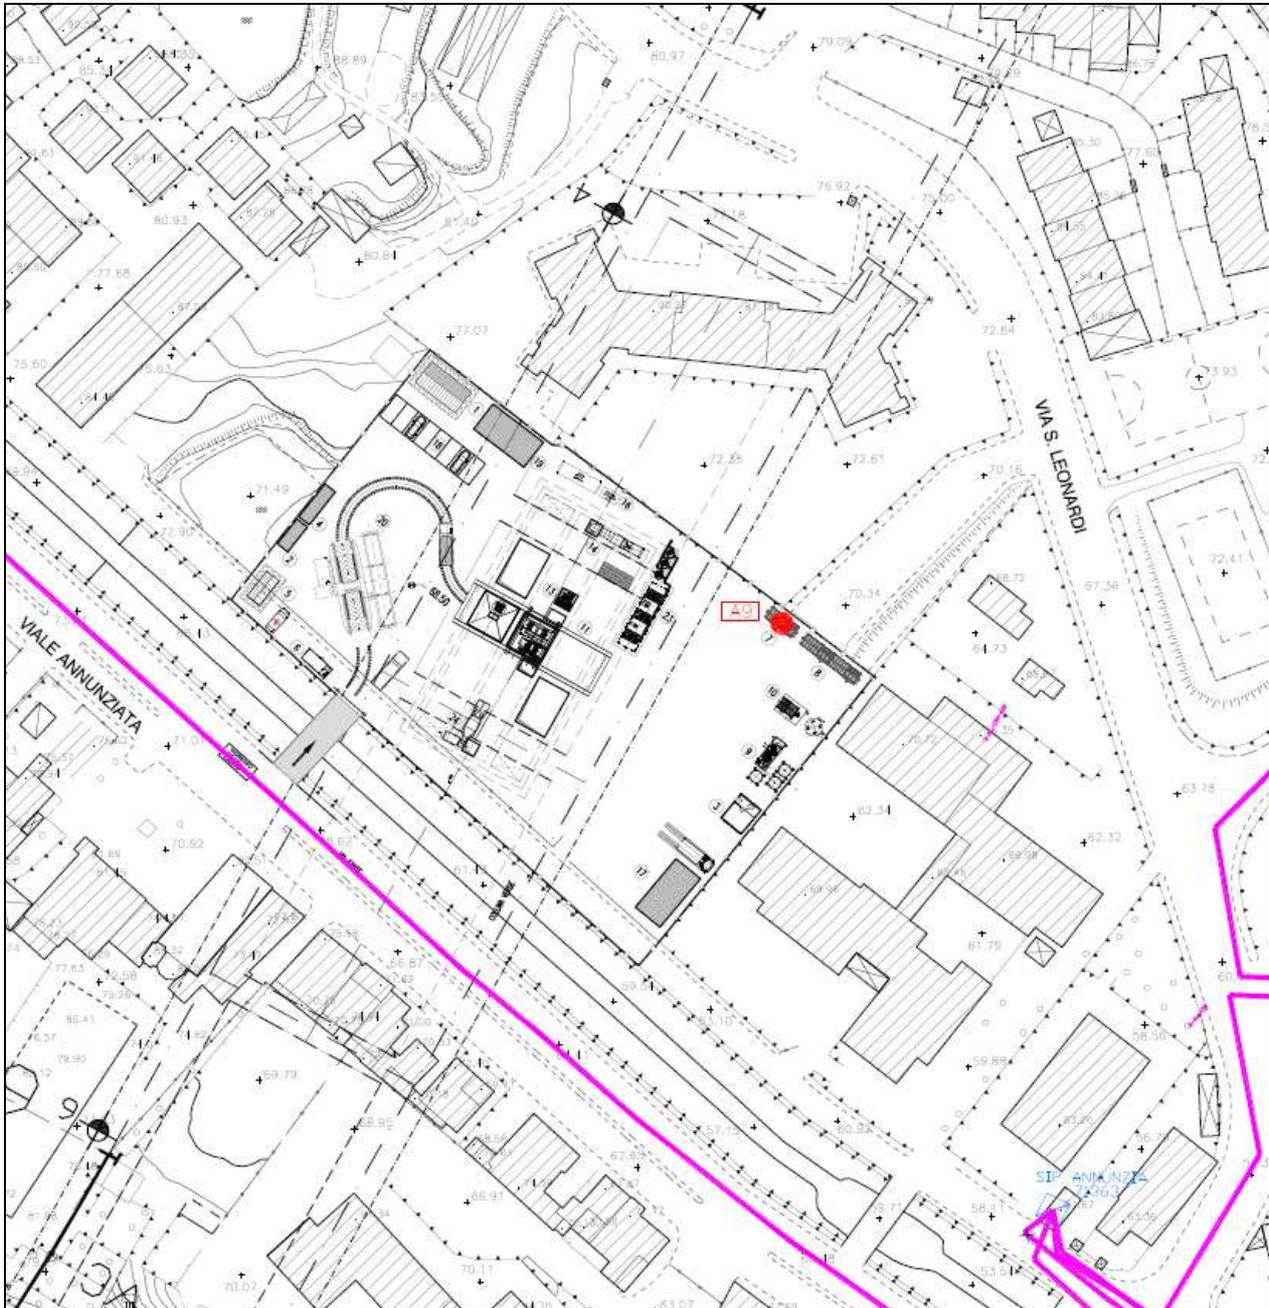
Cantiere SS2 Stazione Annunziata – Localizzazione punti allacciamento
